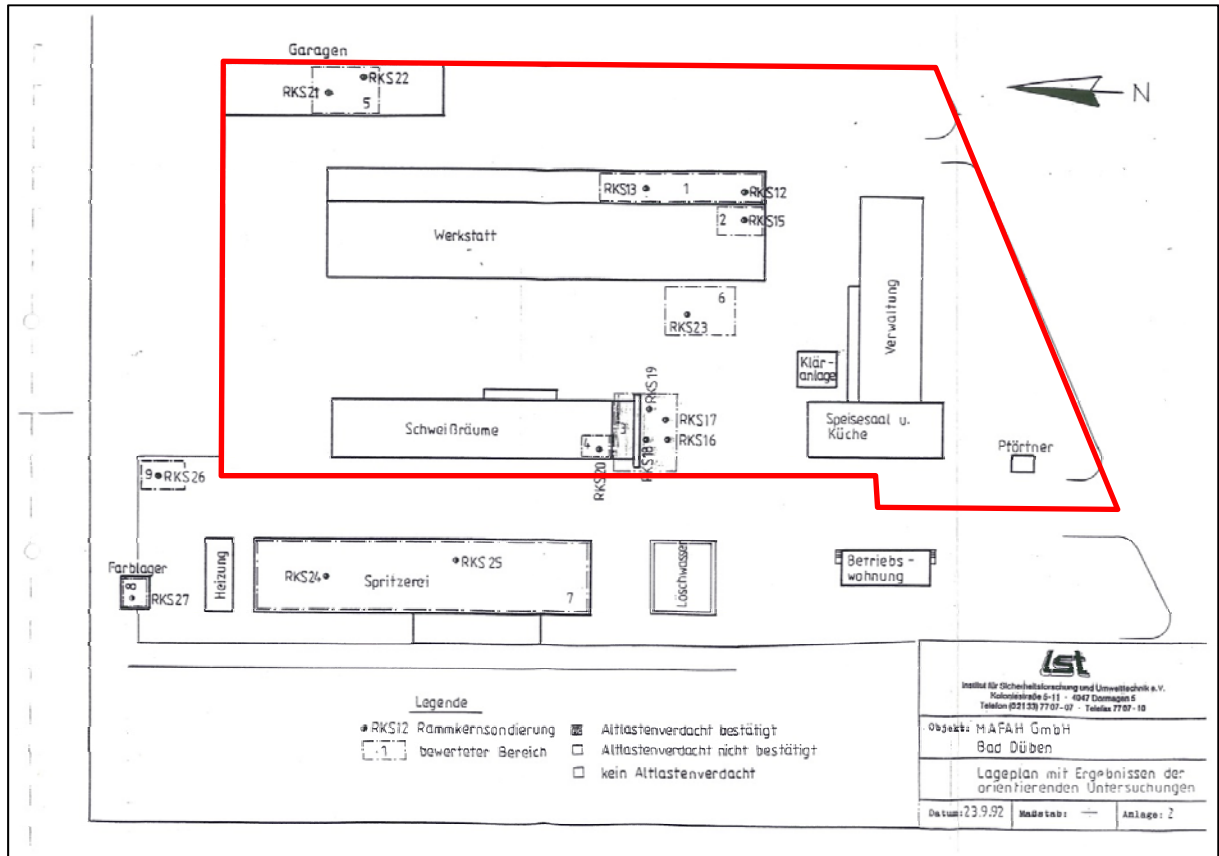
Lageplan zum Untersuchungsbericht des Altstandortes mit Plangebiet, ohne Maßstab
